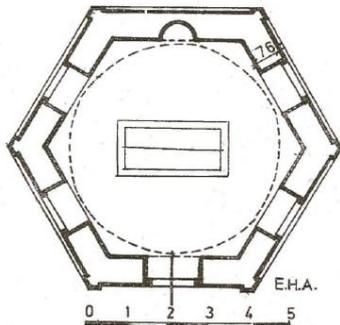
مسقط أفقي لتربة غازي مراد بك في البوسنة عن:
